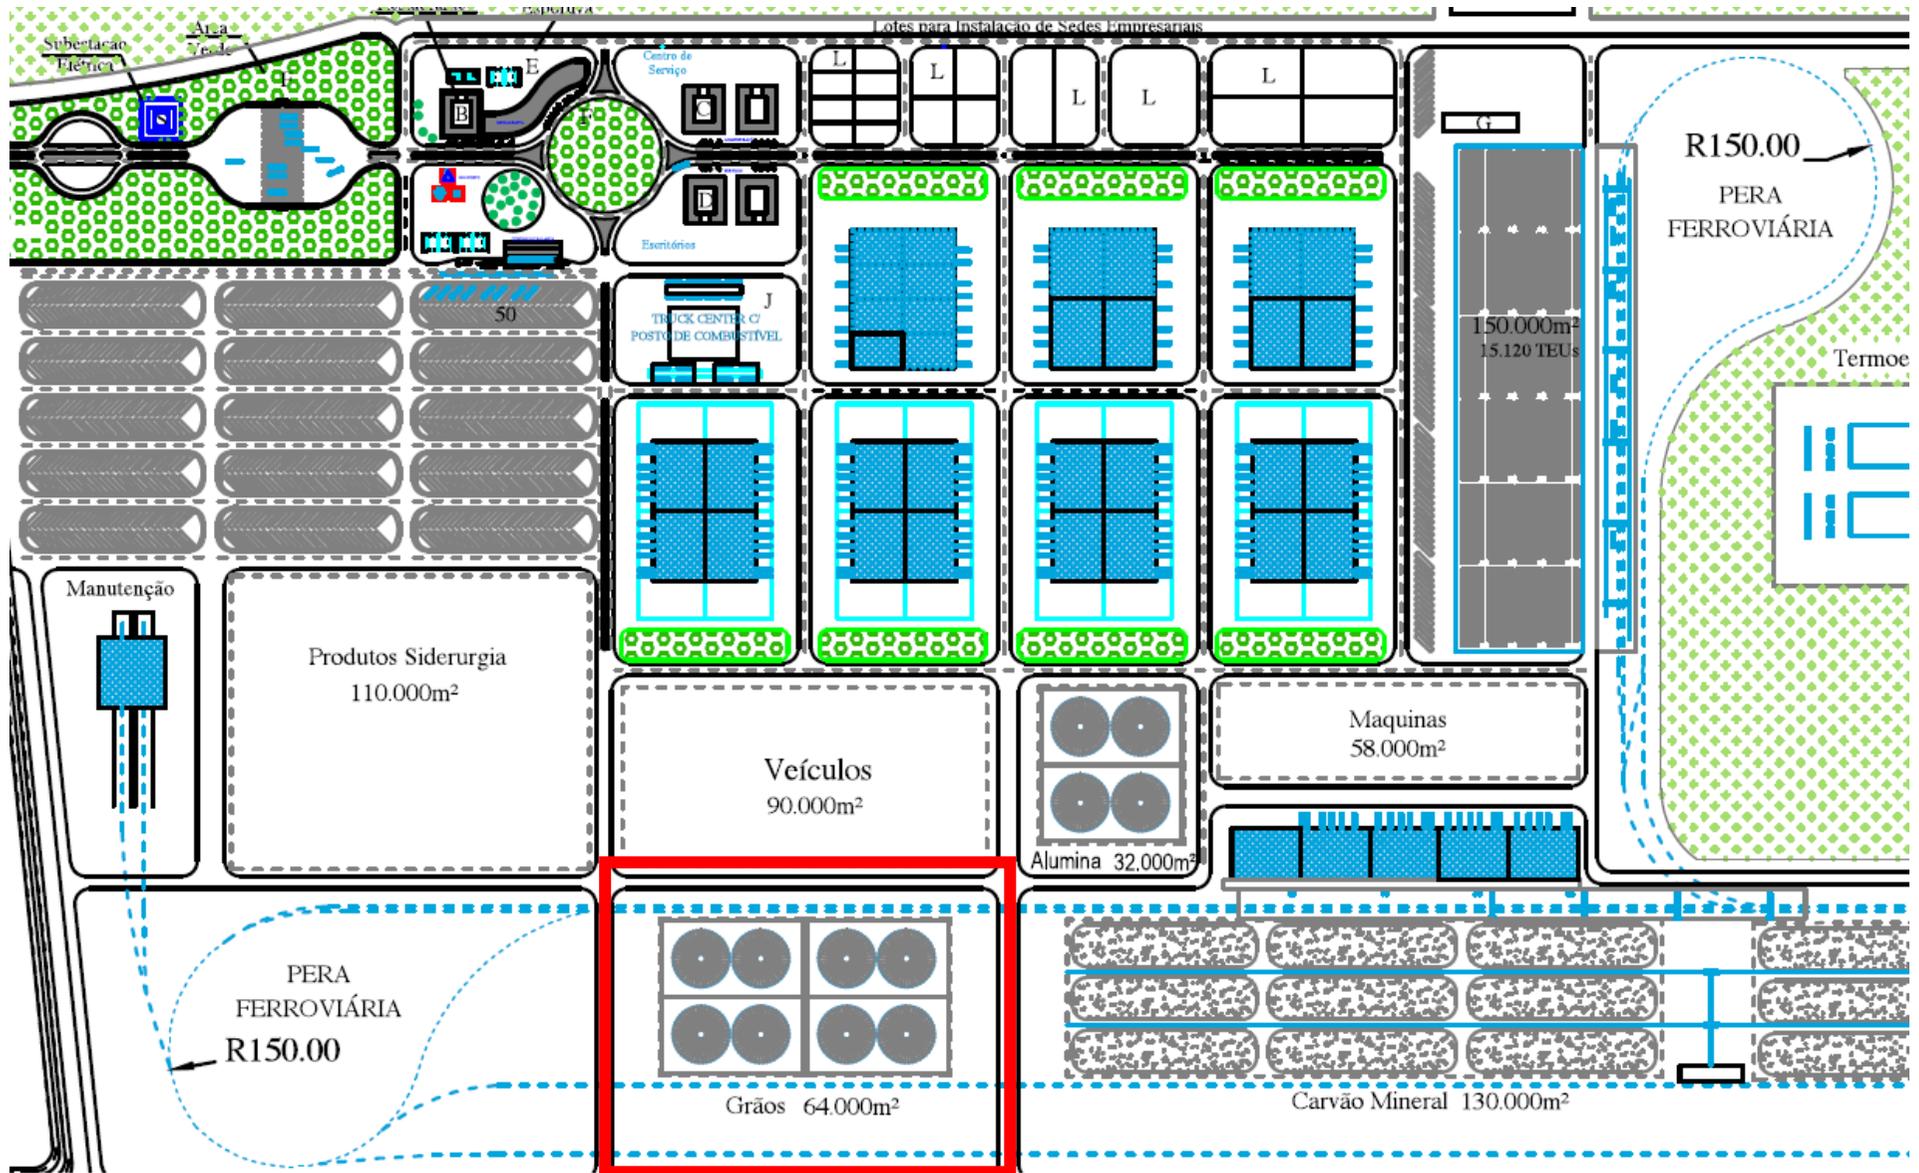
Layout do Master Plan – Projeto Piloto.
